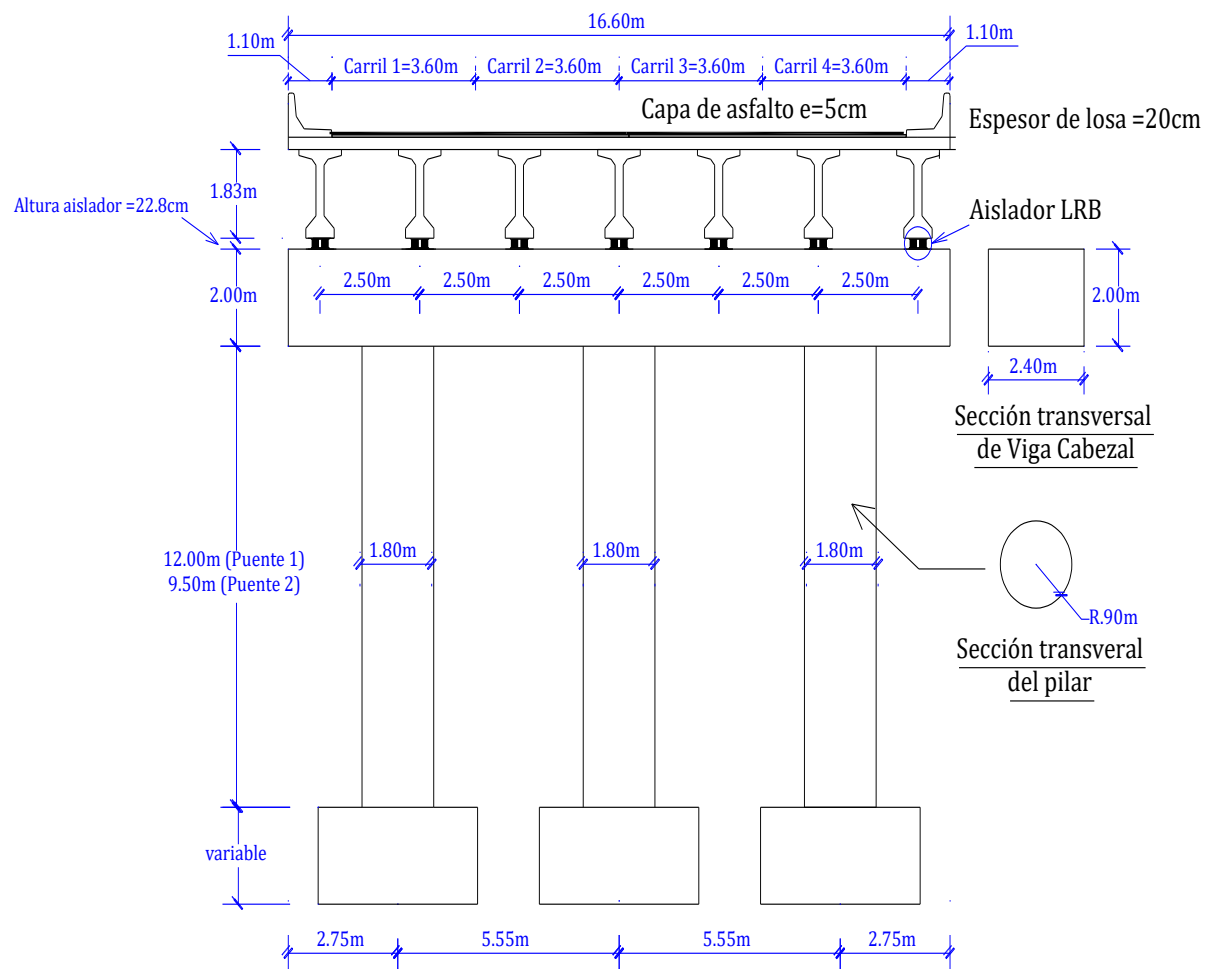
Sección transversal típica de los puentes preesforzados con aislamiento sísmico.
